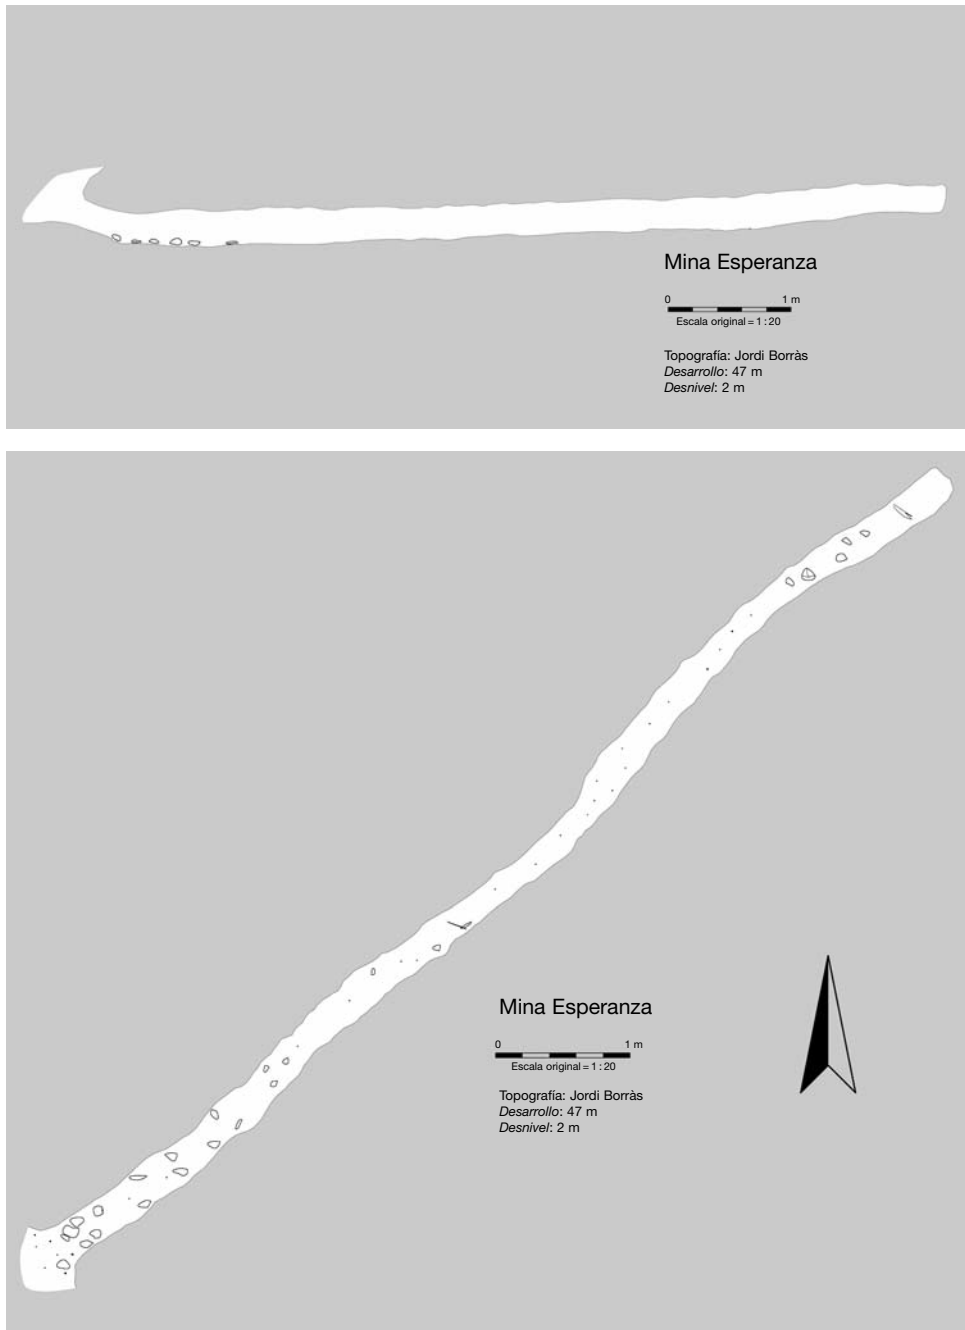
Perfil y planta de socavón minero en Labaza (valle de Bujaruelo).
